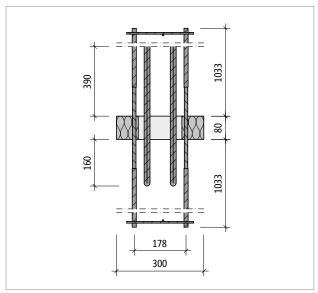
Schöck Sconnex® type W-N1T1-V1H1-LW : coupe A-A du produit
